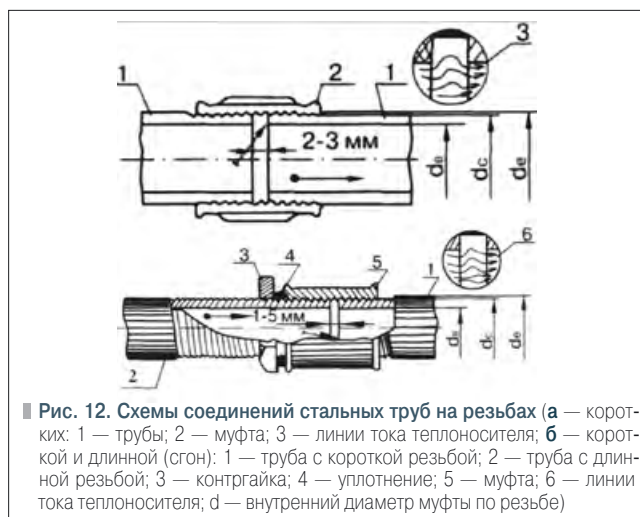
Схемы соединений стальных труб на резьбах (а — коротких: 1 — трубы; 2 — муфта; 3 — линии тока теплоносителя; б — короткой и длинной (сгон): 1 — труба с короткой резьбой; 2 — труба с длинной резьбой; 3 — контргайка; 4 — уплотнение; 5 — муфта; 6 — линии тока теплоносителя; d — внутренний диаметр муфты по резьбе)
